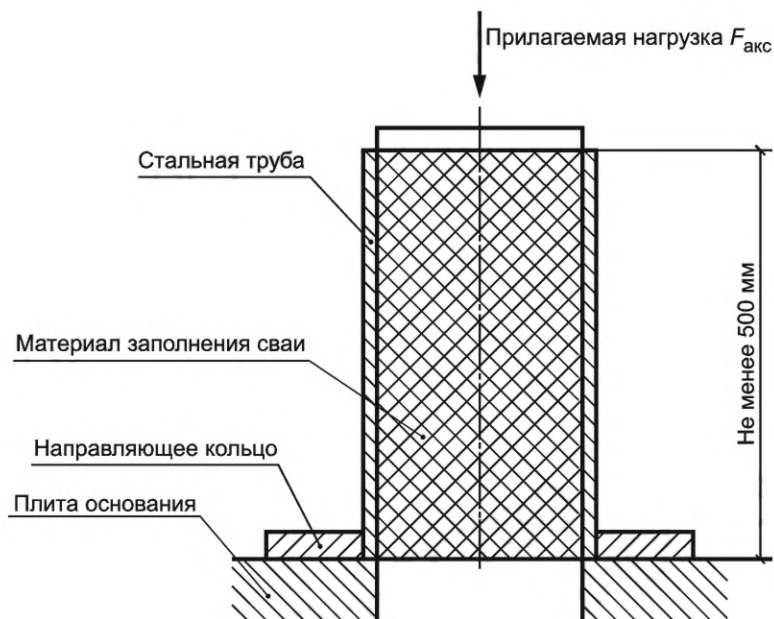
Схема проведения испытаний на сдвиг по стенке
